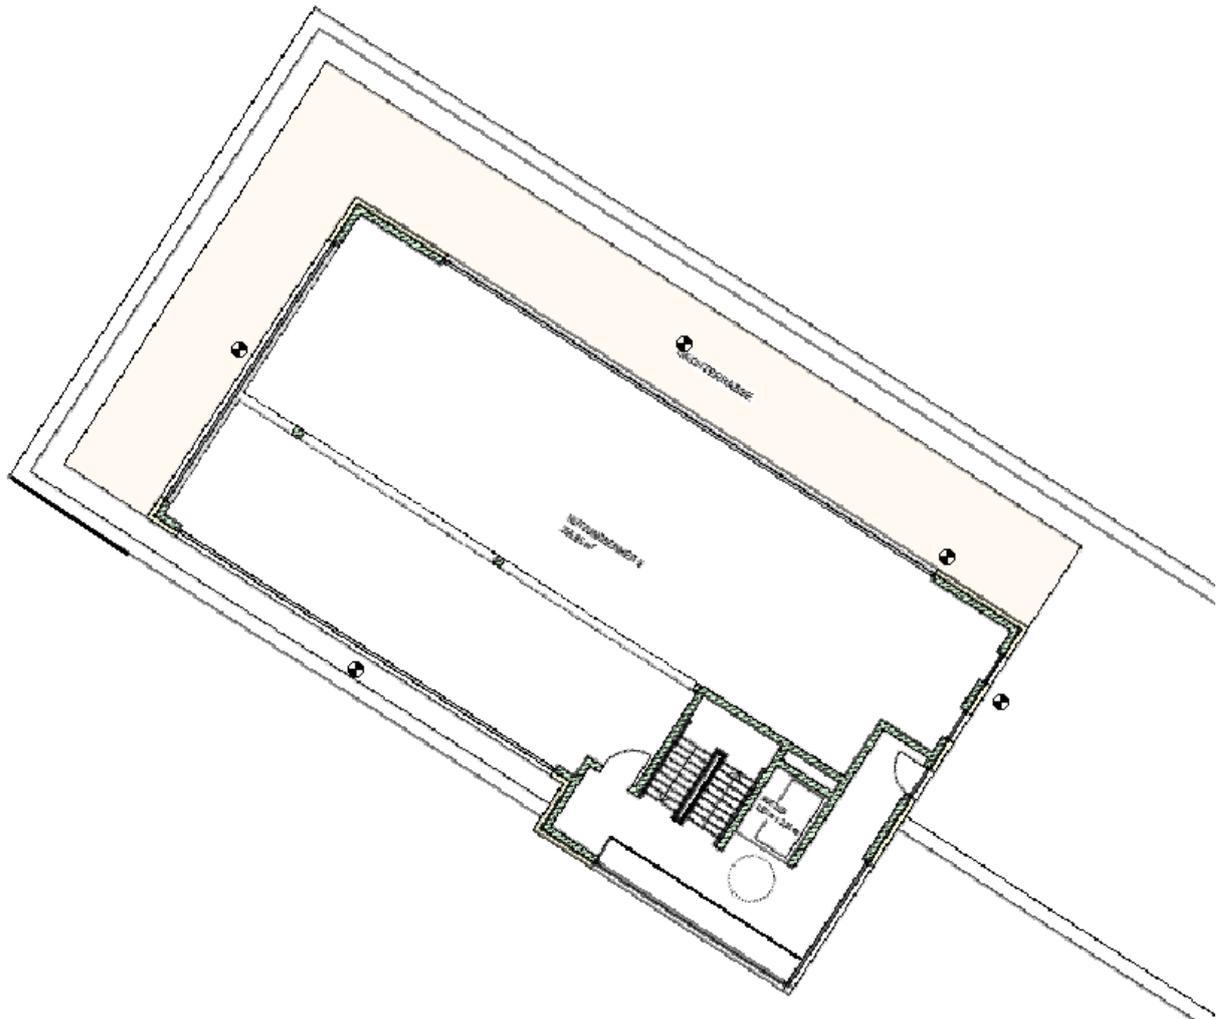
Auszug Grundriss Dachgeschoss, Entwurf vom 04.03.2022
